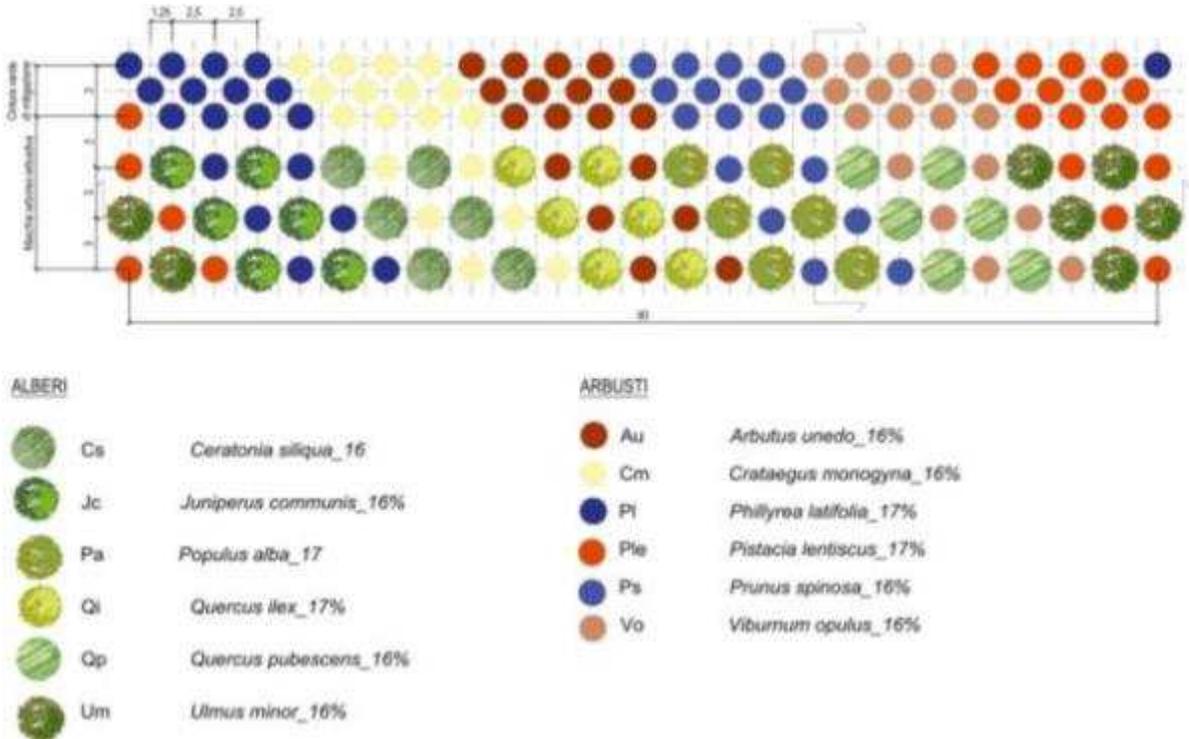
Sesto d'impianto e sezione tipologica PA2
